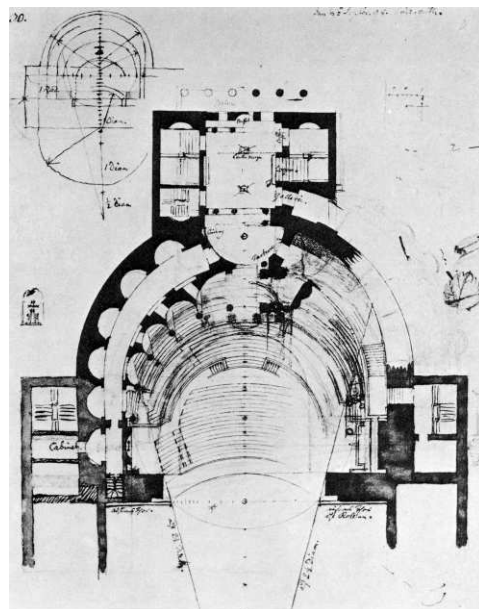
| Friedrich Gilly: Schauspielhaus: Grundriss der Nordseite (1798; verschollen) (WV: B 30, R: Abb. 106).
